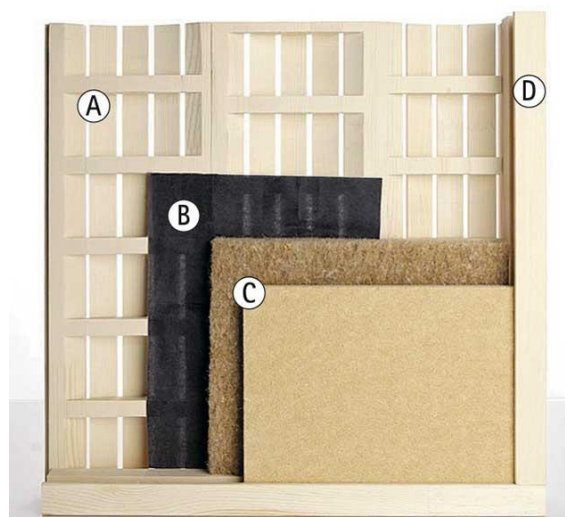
Sistema fonoabsorbente de paneles de madera laminada
